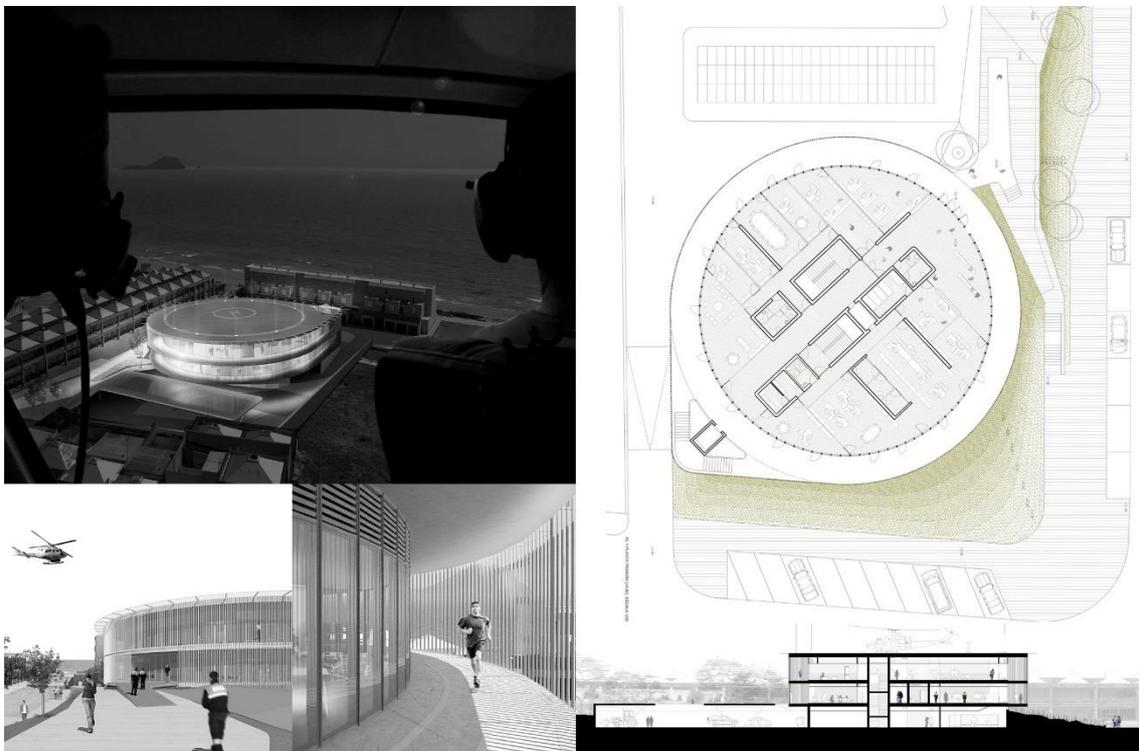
Vista desde helicóptero, vista acceso, corredor interior, planta y sección.
